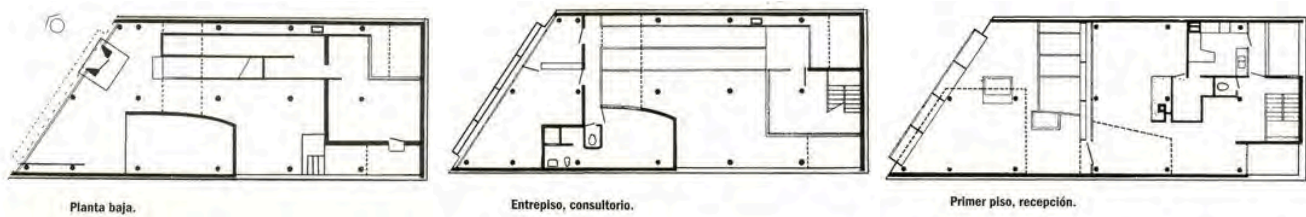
Plantas arquitectónicas, de la casa Curruchet, donde se observa que el sembrado de las columnas no corresponde al proyecto.
